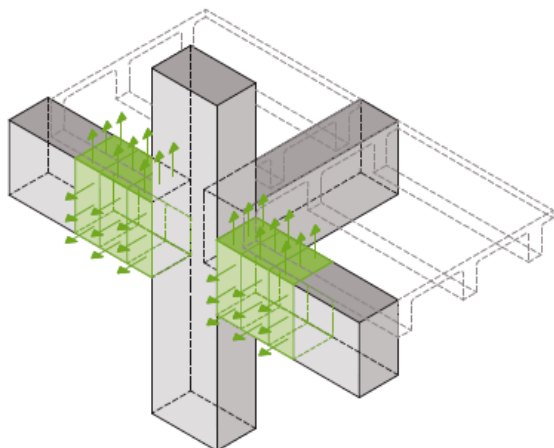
Refuerzo a cortante de en los apoyos de las vigas.
